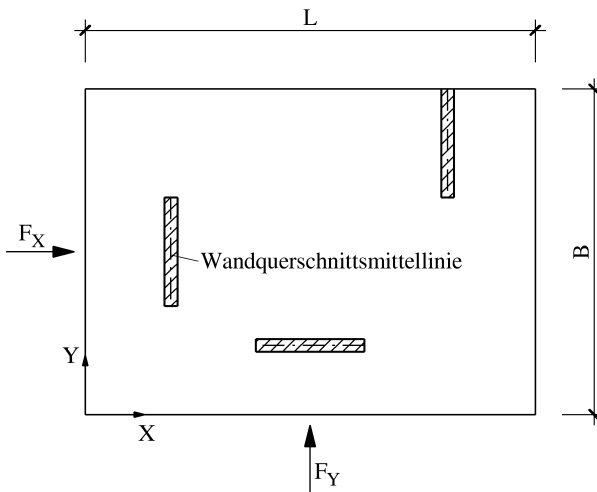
Statisch bestimmter Gebäudequerschnitt mit horizontalen Einwirkungen
